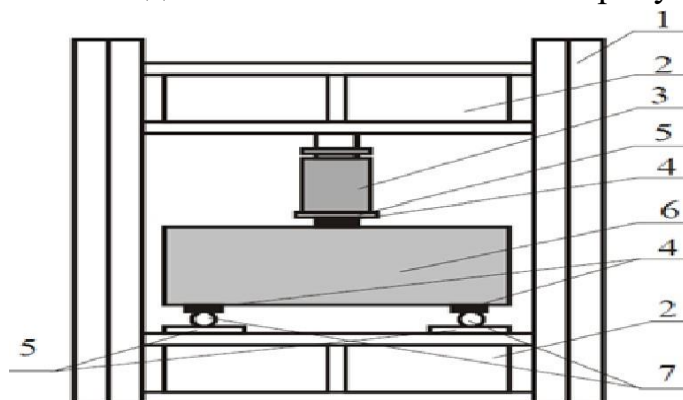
Схема силовой установки испытания образцов-балок:
